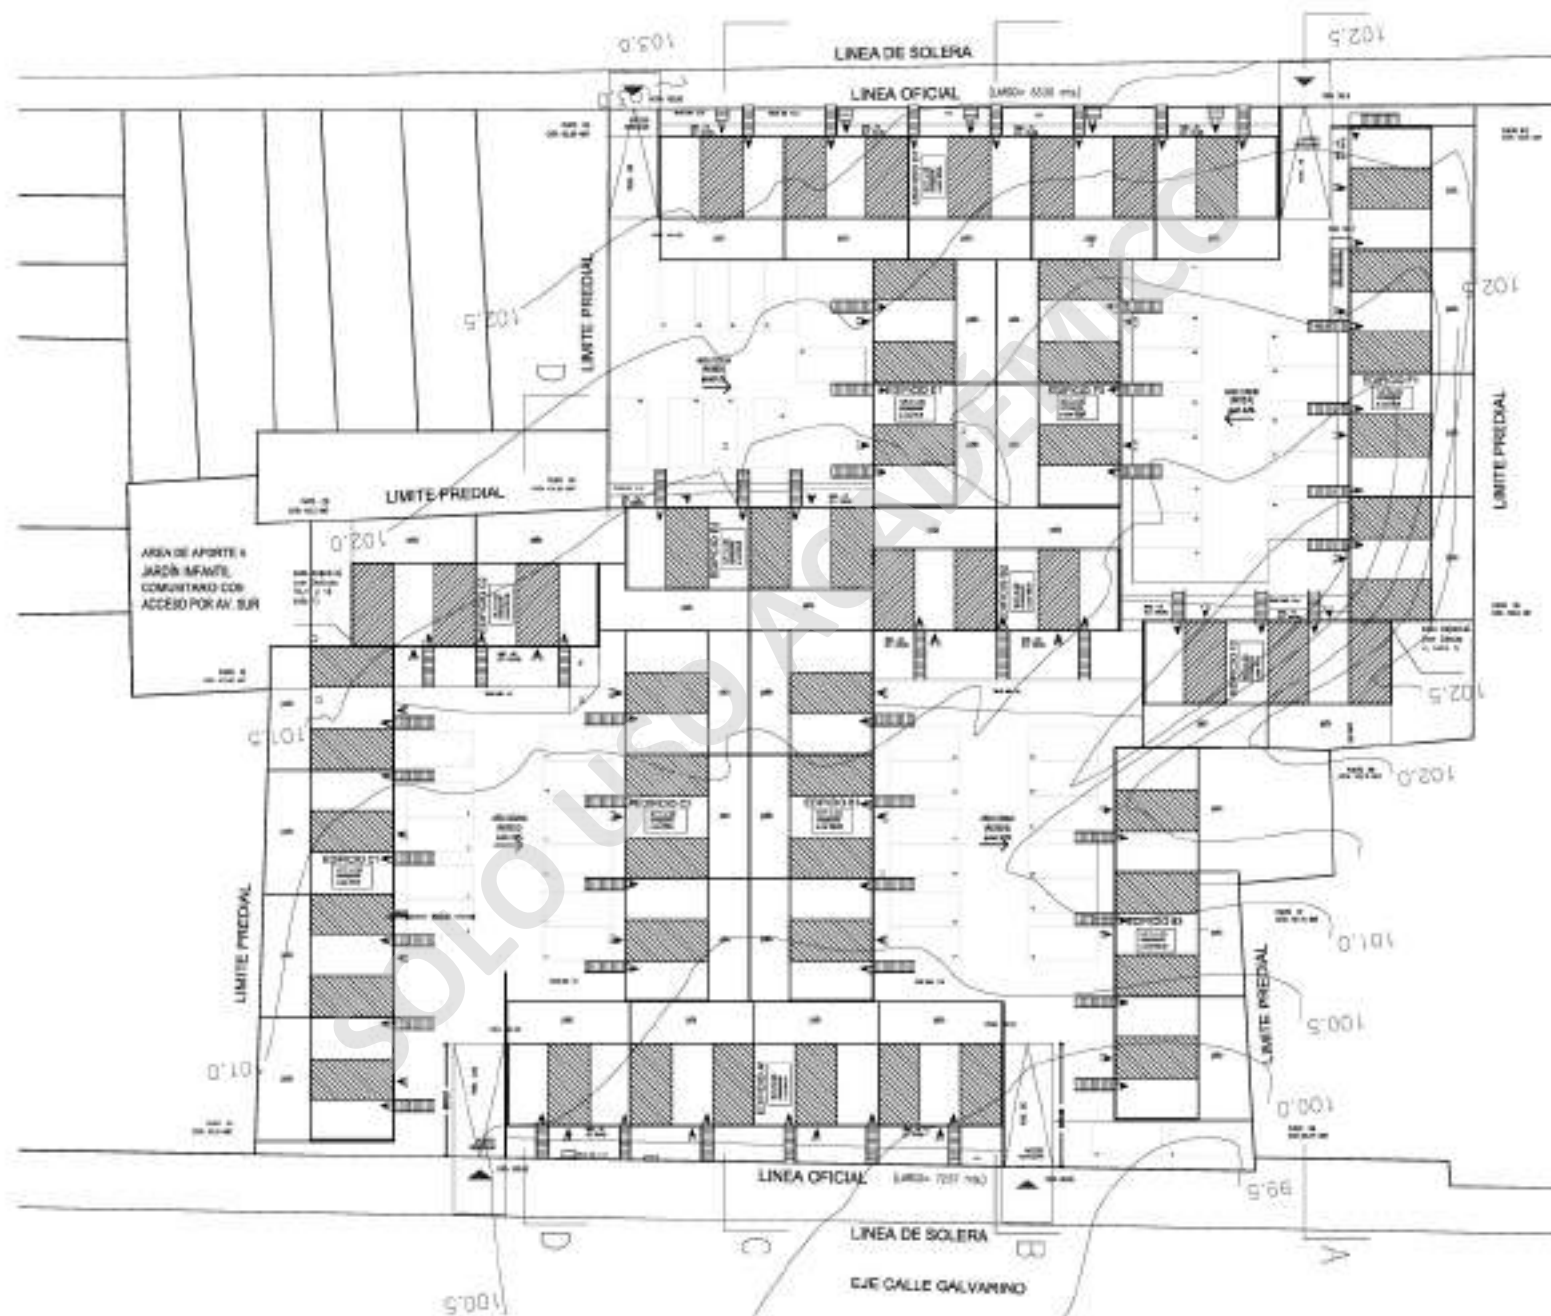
| Planta de arquitectura. Primer piso, Quinta Menrey.
